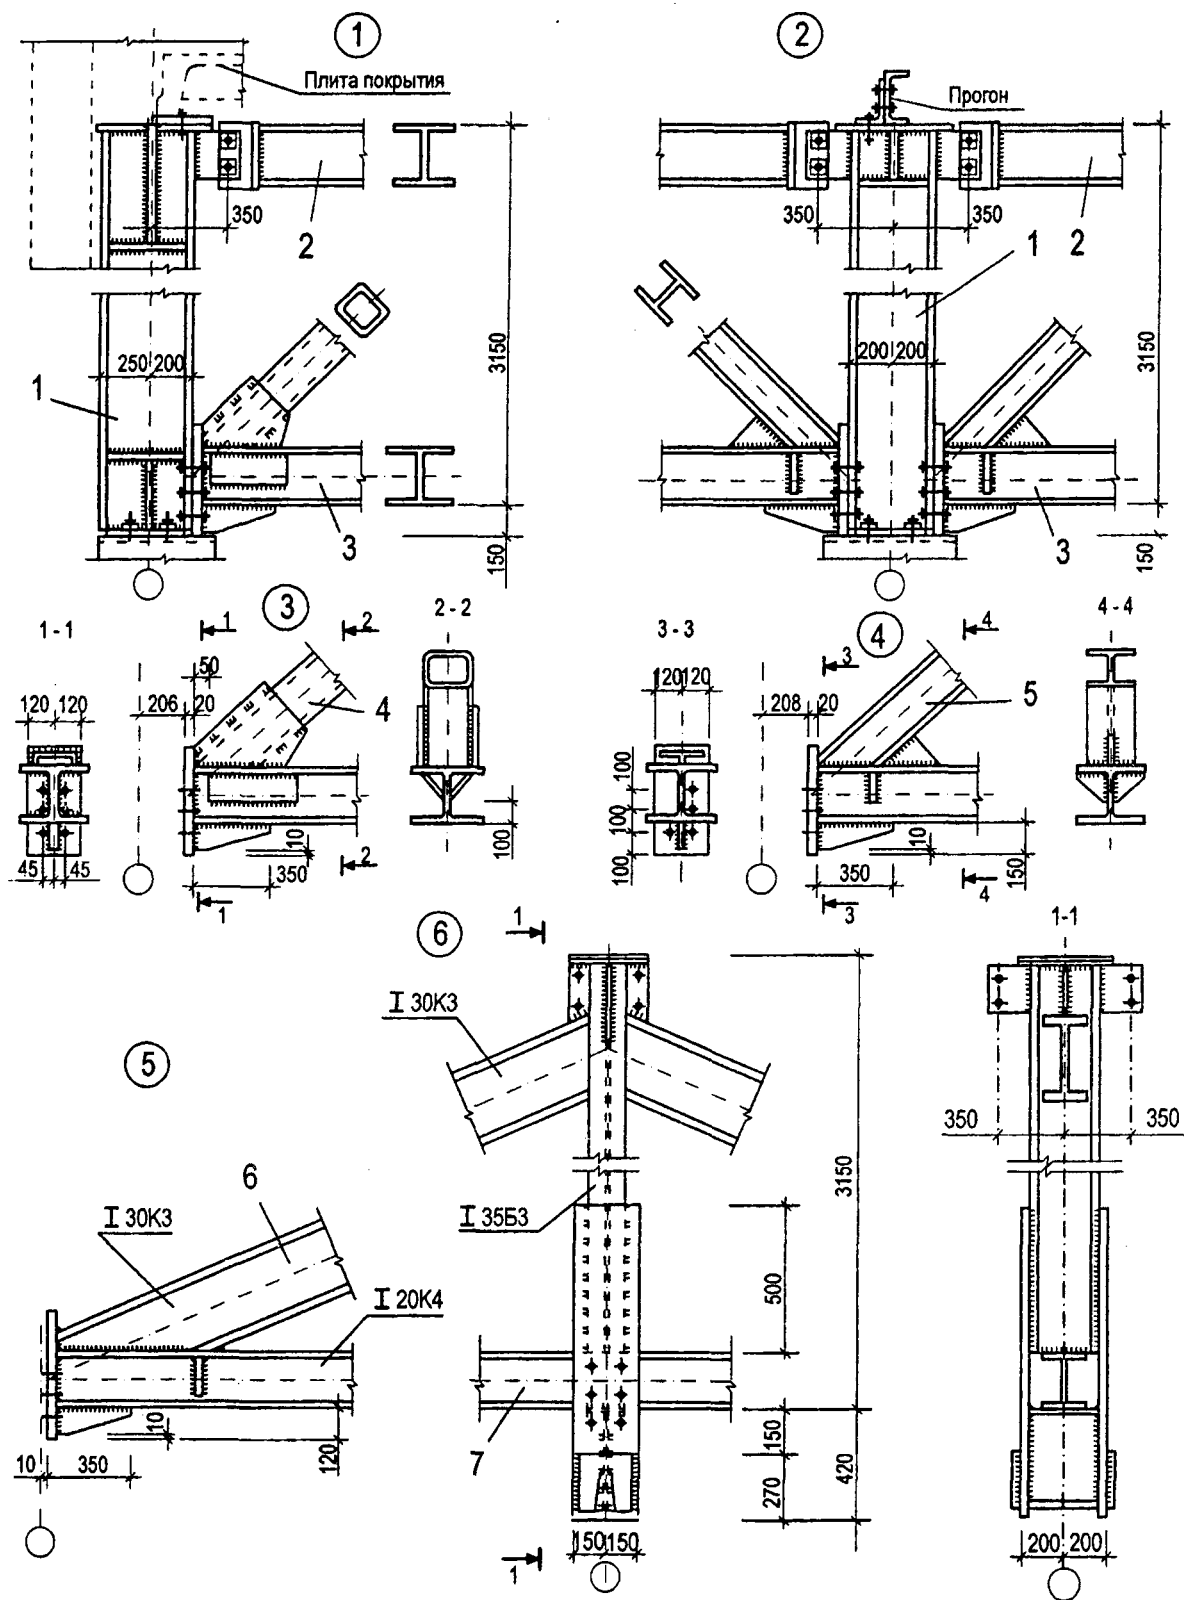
Узлы ферм из широкополочных двутавров:
